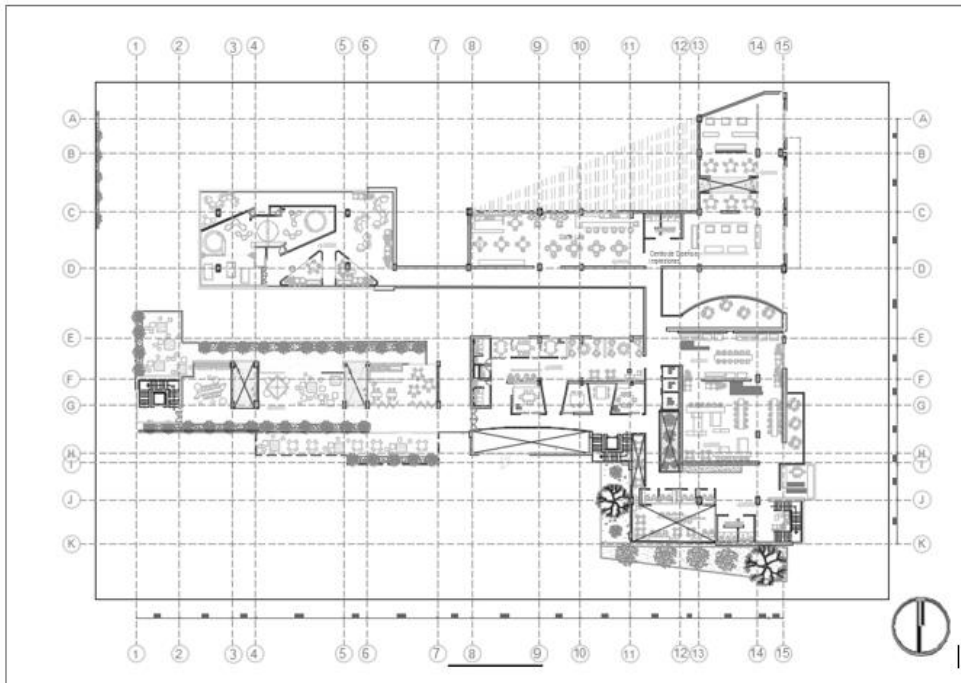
Propuesta planta tercer nivel. Autoría propia (2020)
